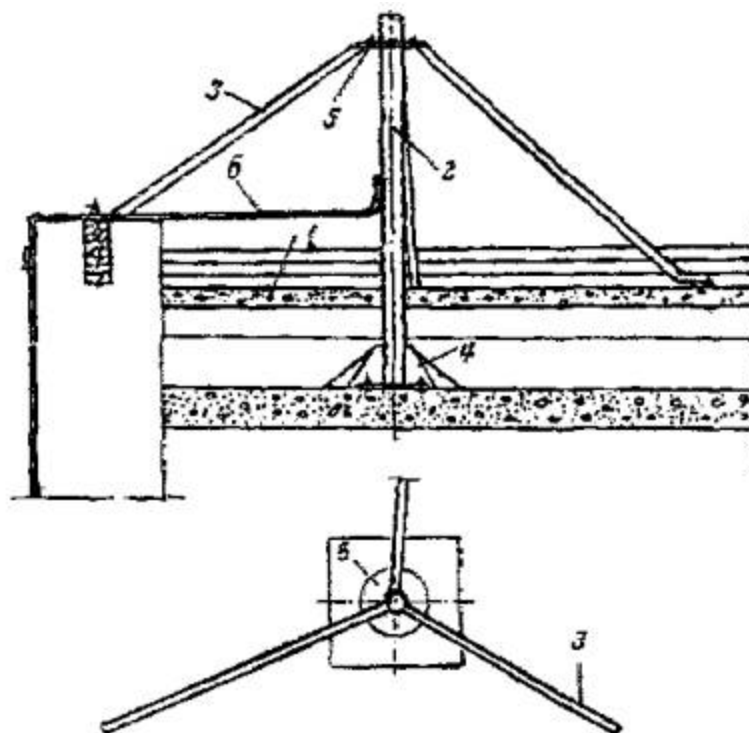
Крепление стержневых молниеотводов $h = 5 - 10$ м на бетонной кровле:
